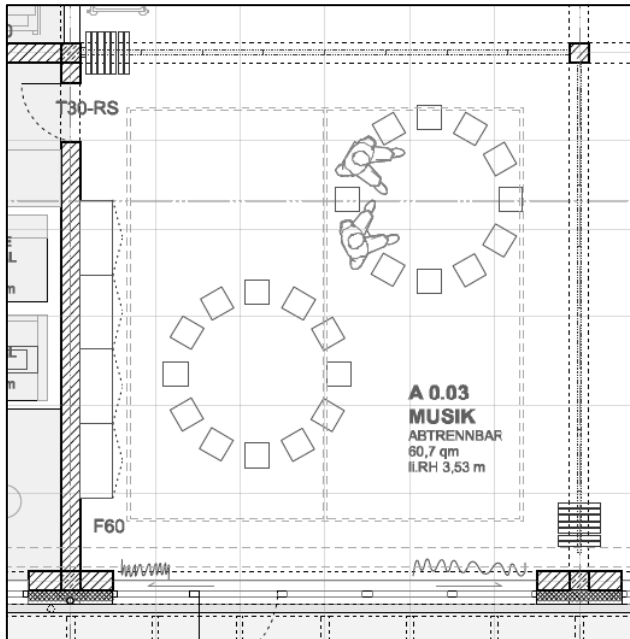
Grundriss Musikraum, unmaßstäblich /13/
